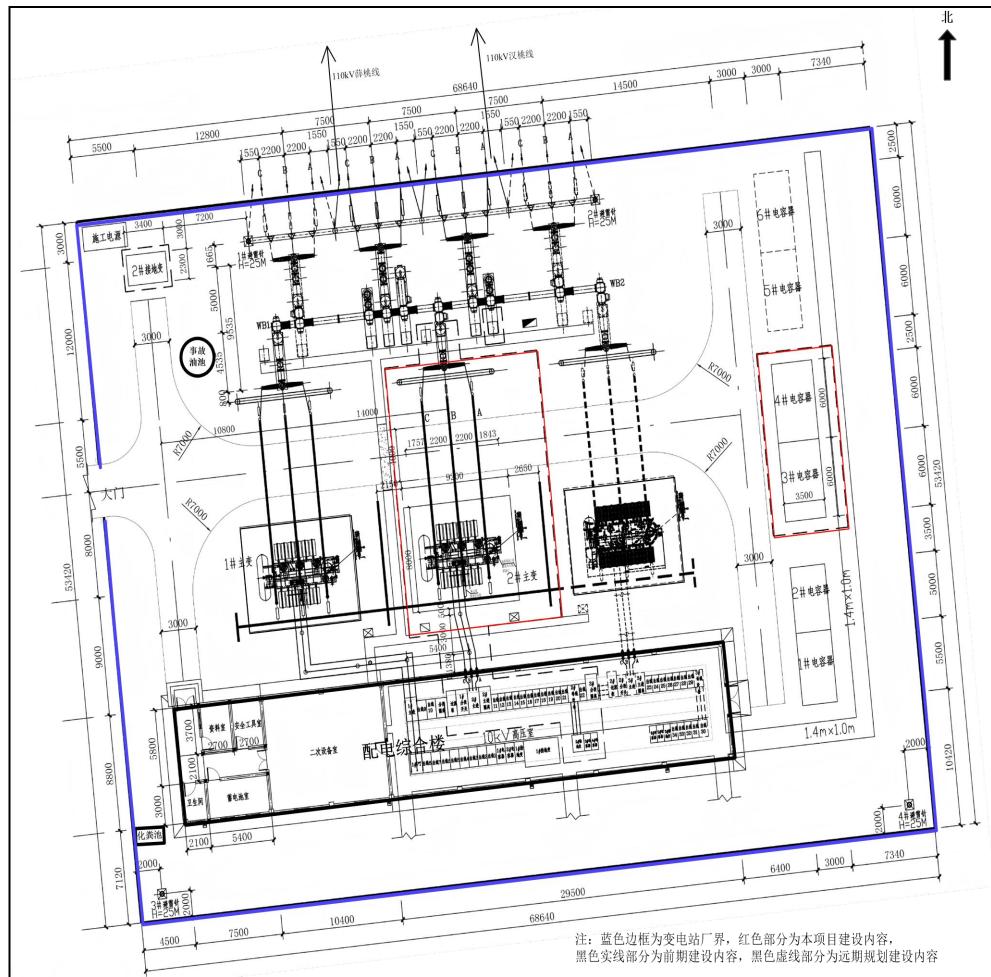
许昌市区桃源 110 千伏变电站平面布置示意图
